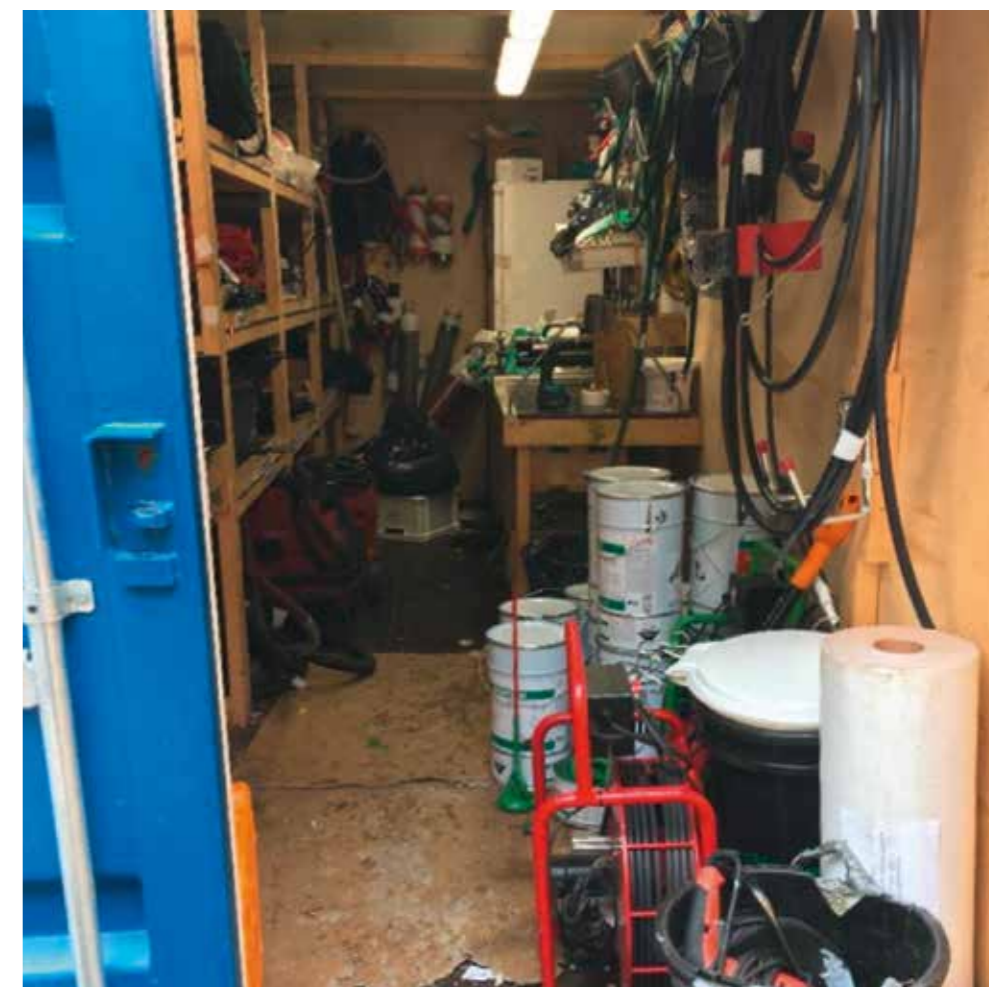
Conteneur de chantier avec l'équipement technique sur le chantier de construction à Helsinki-Pehlajesto
